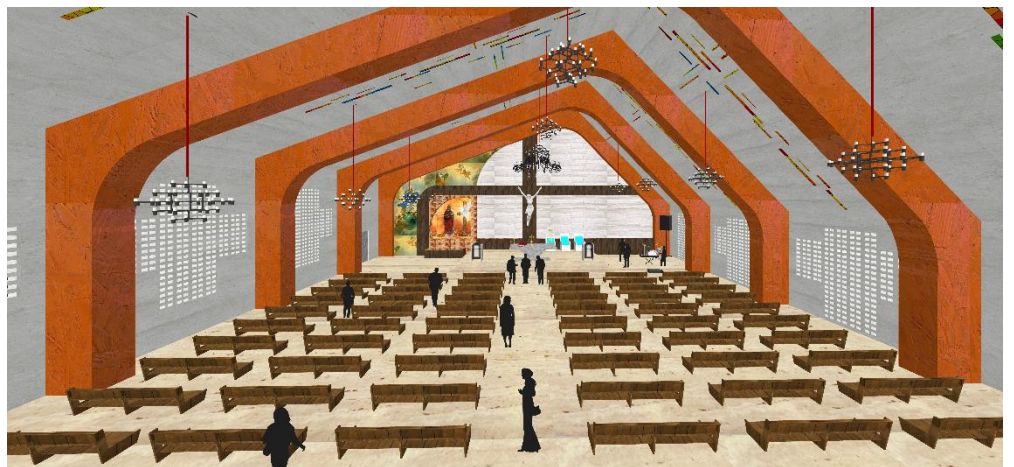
PERSPECTIVA MOSTRANDO LA PLANTA ARQUITECTÓNICA
